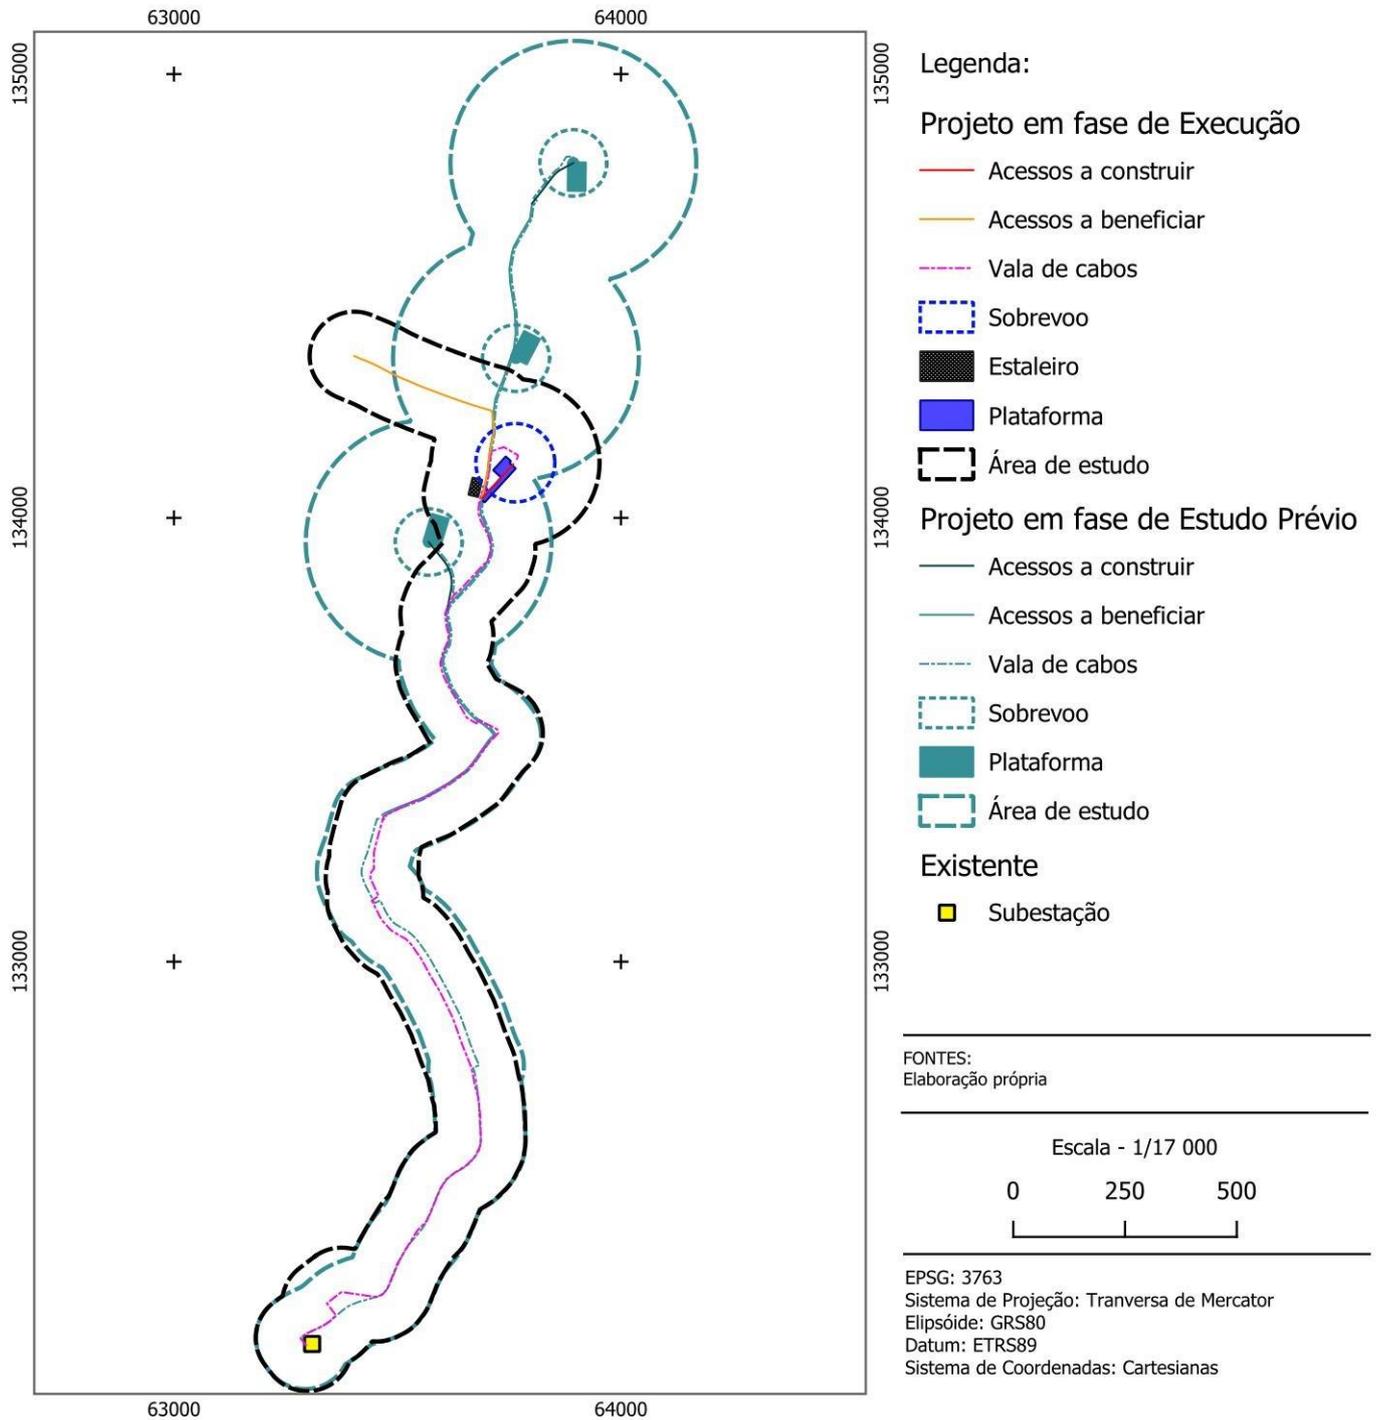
Comparação entre o Projeto apresentado em fase de Estudo Prévio, e o Projeto apresentado em fase de Projeto de Execução.
